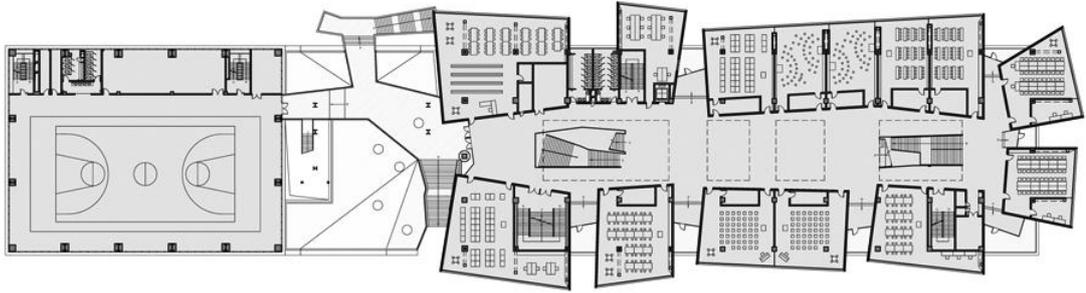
PLANTA SEGUNDO PAVIMENTO
